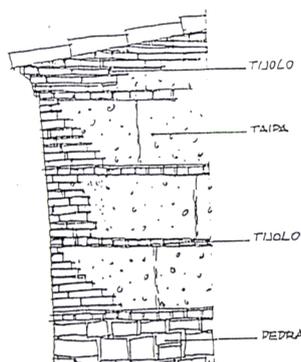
Taipa, pormenor construtivo de uma parede em taipa
